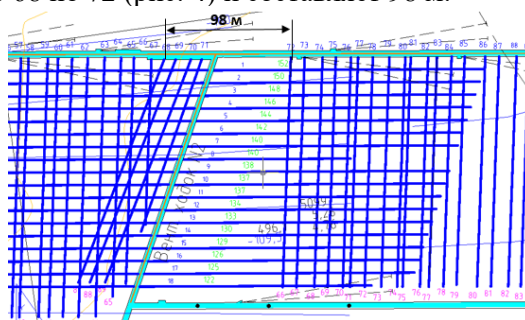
Зона снижения геостатических напряжений, вызванное проходкой вентиляционного ходка № 2
